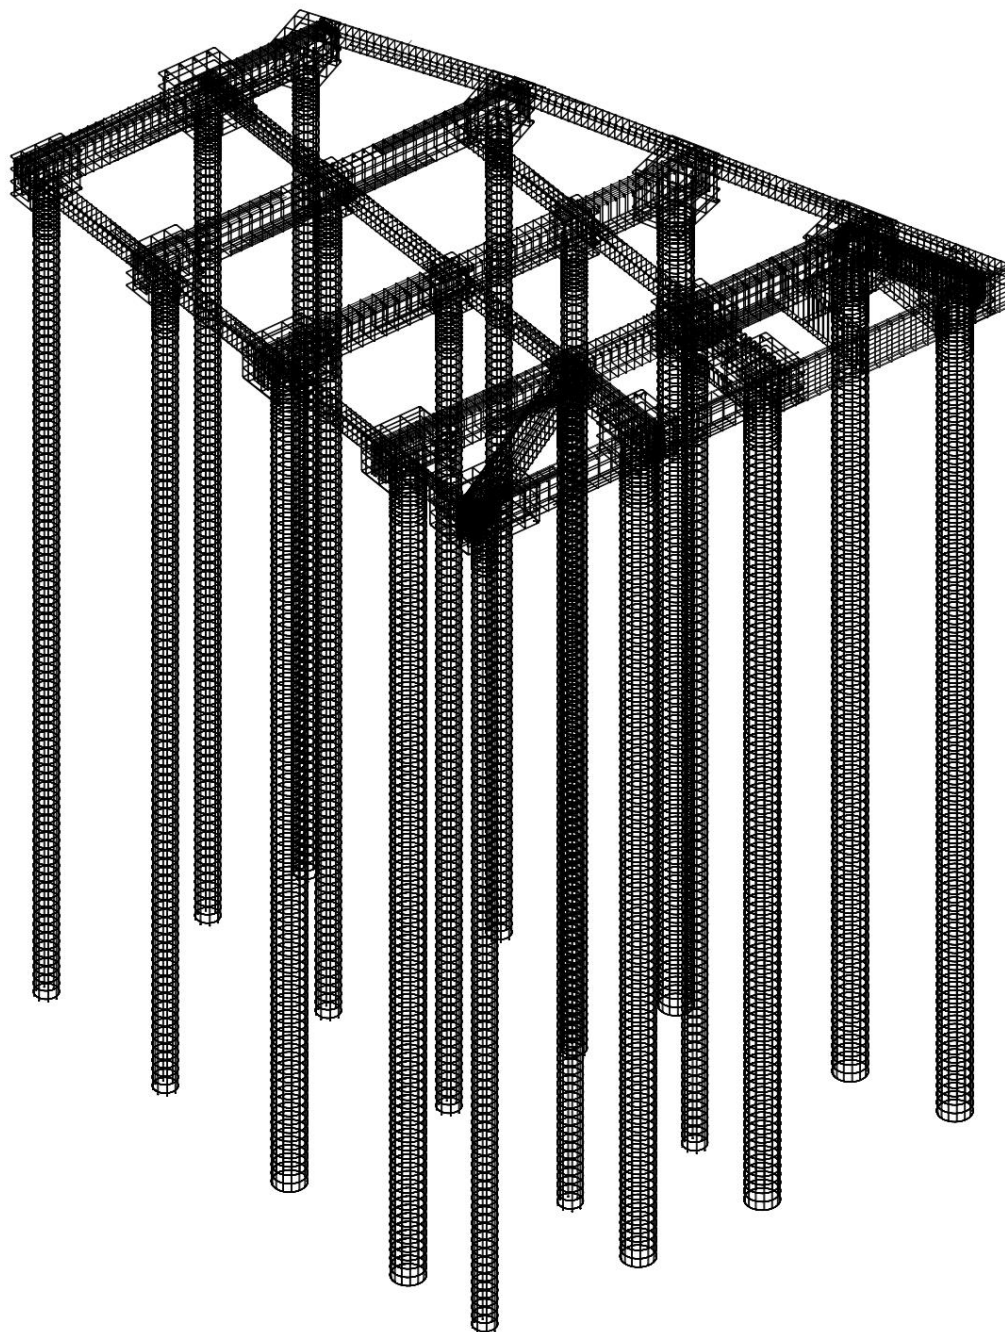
Vista 3D de Hormigón del sistema de fundación recomendado.
